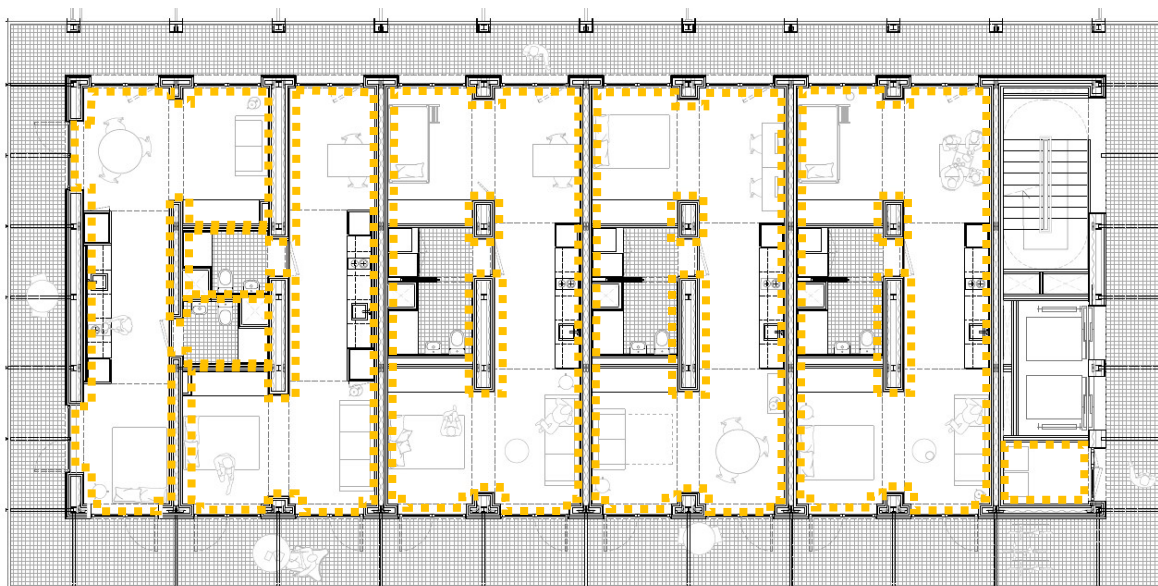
Planta tipus d'allotjaments, indicant juntes perimetrals verticals del paviment flotant
